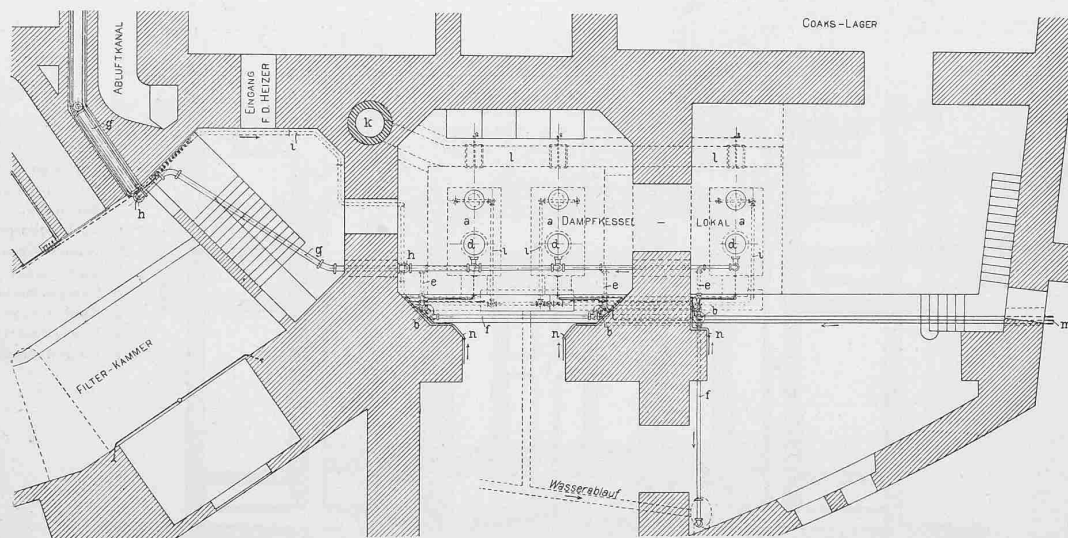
Die Niederdruckdampfessel-Anlage. — Grundriss 1:200.
